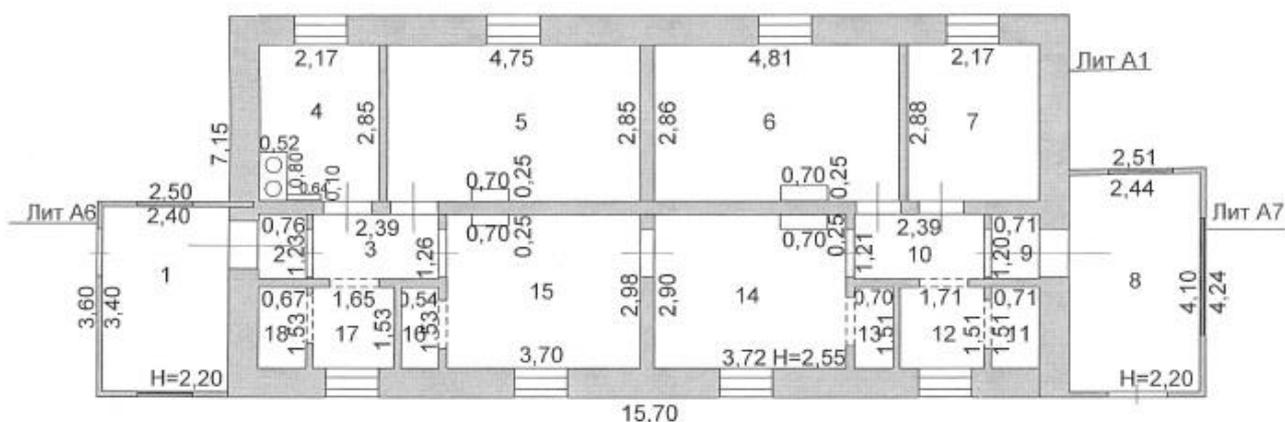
Поэтажный план жилого дома, площадью 94,5 кв.м
